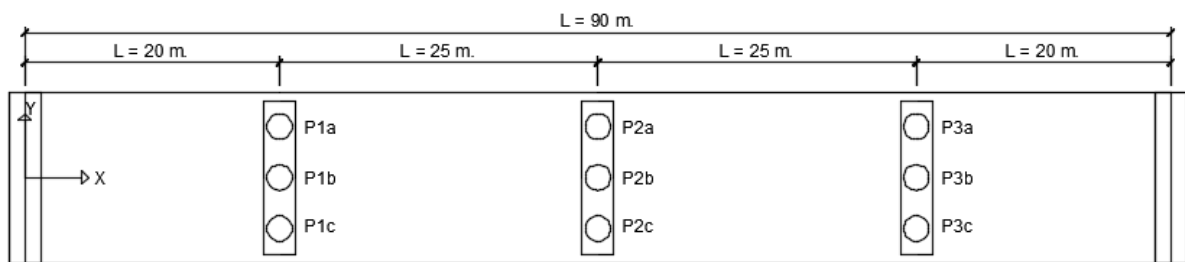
Vista de planta del puente con su respectiva nomenclatura de pilares
